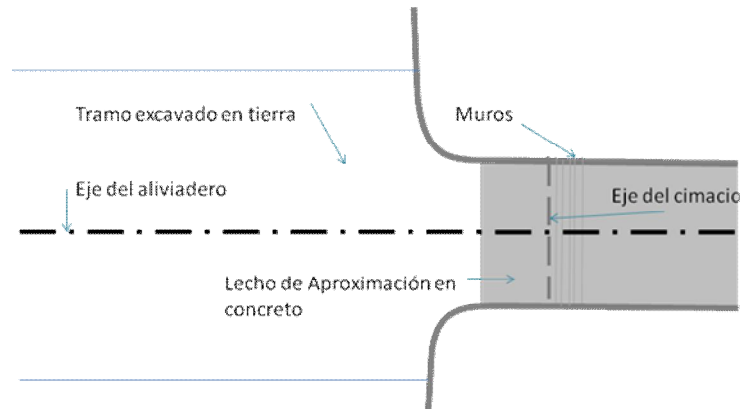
Vista en planta de la perspectiva de canal de aproximación.
